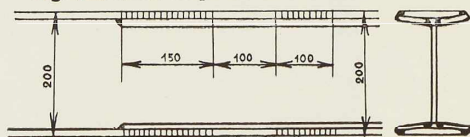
Poutrelle horizontale renforcée par soudure sans en augmenter la hauteur.
